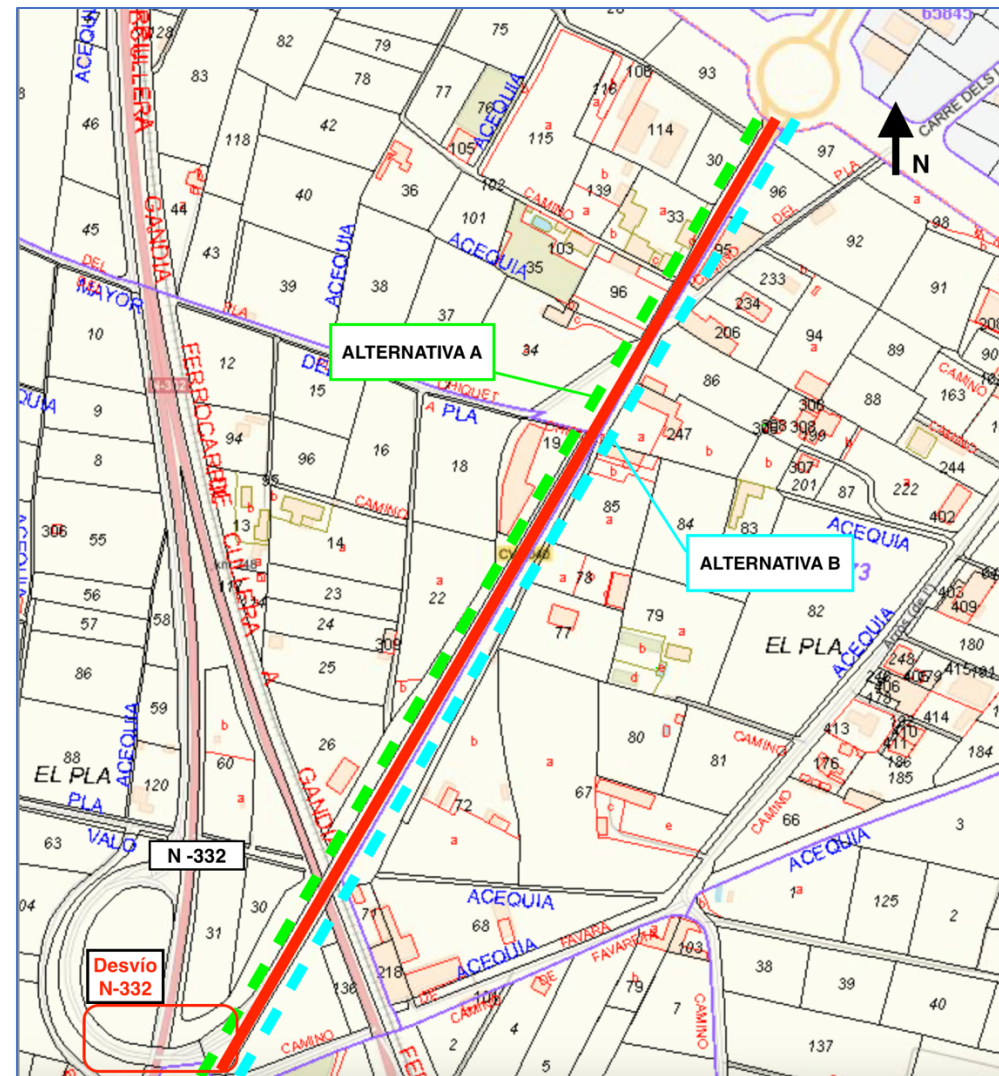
Alternativas trazado en planta. | Fuente: Adaptado Visor Sede Electrónica Catastro
